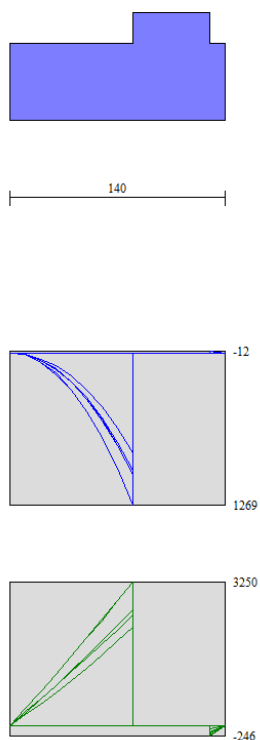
Spalla – Sollecitazioni fondazione
